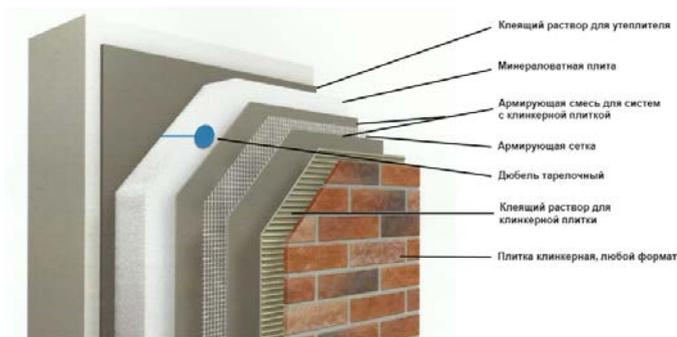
Система утепления фасадов с финишным покрытием из клинкерной плитки
